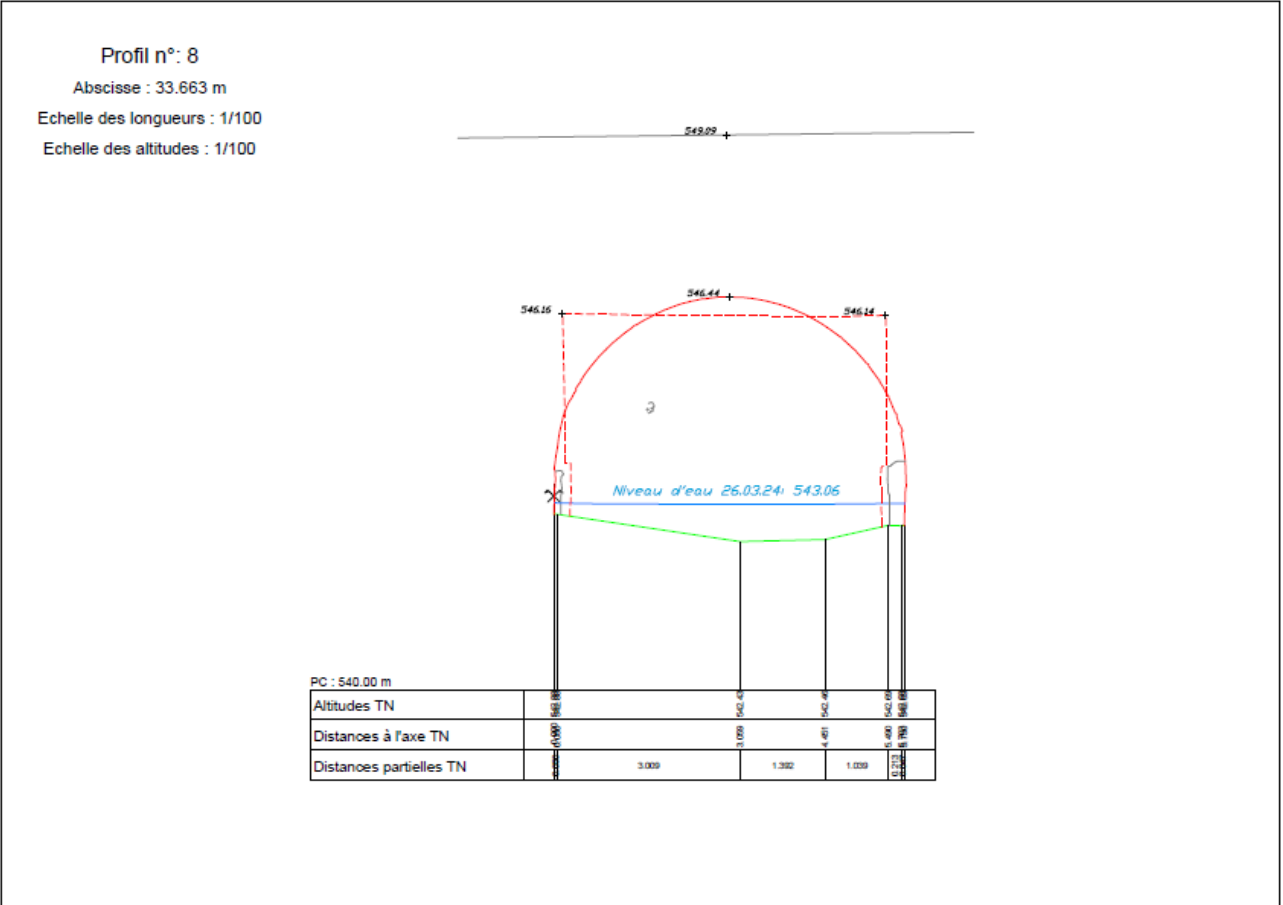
Profil à la jonction entre ouvrage maçonné et ouvrage béton armé
